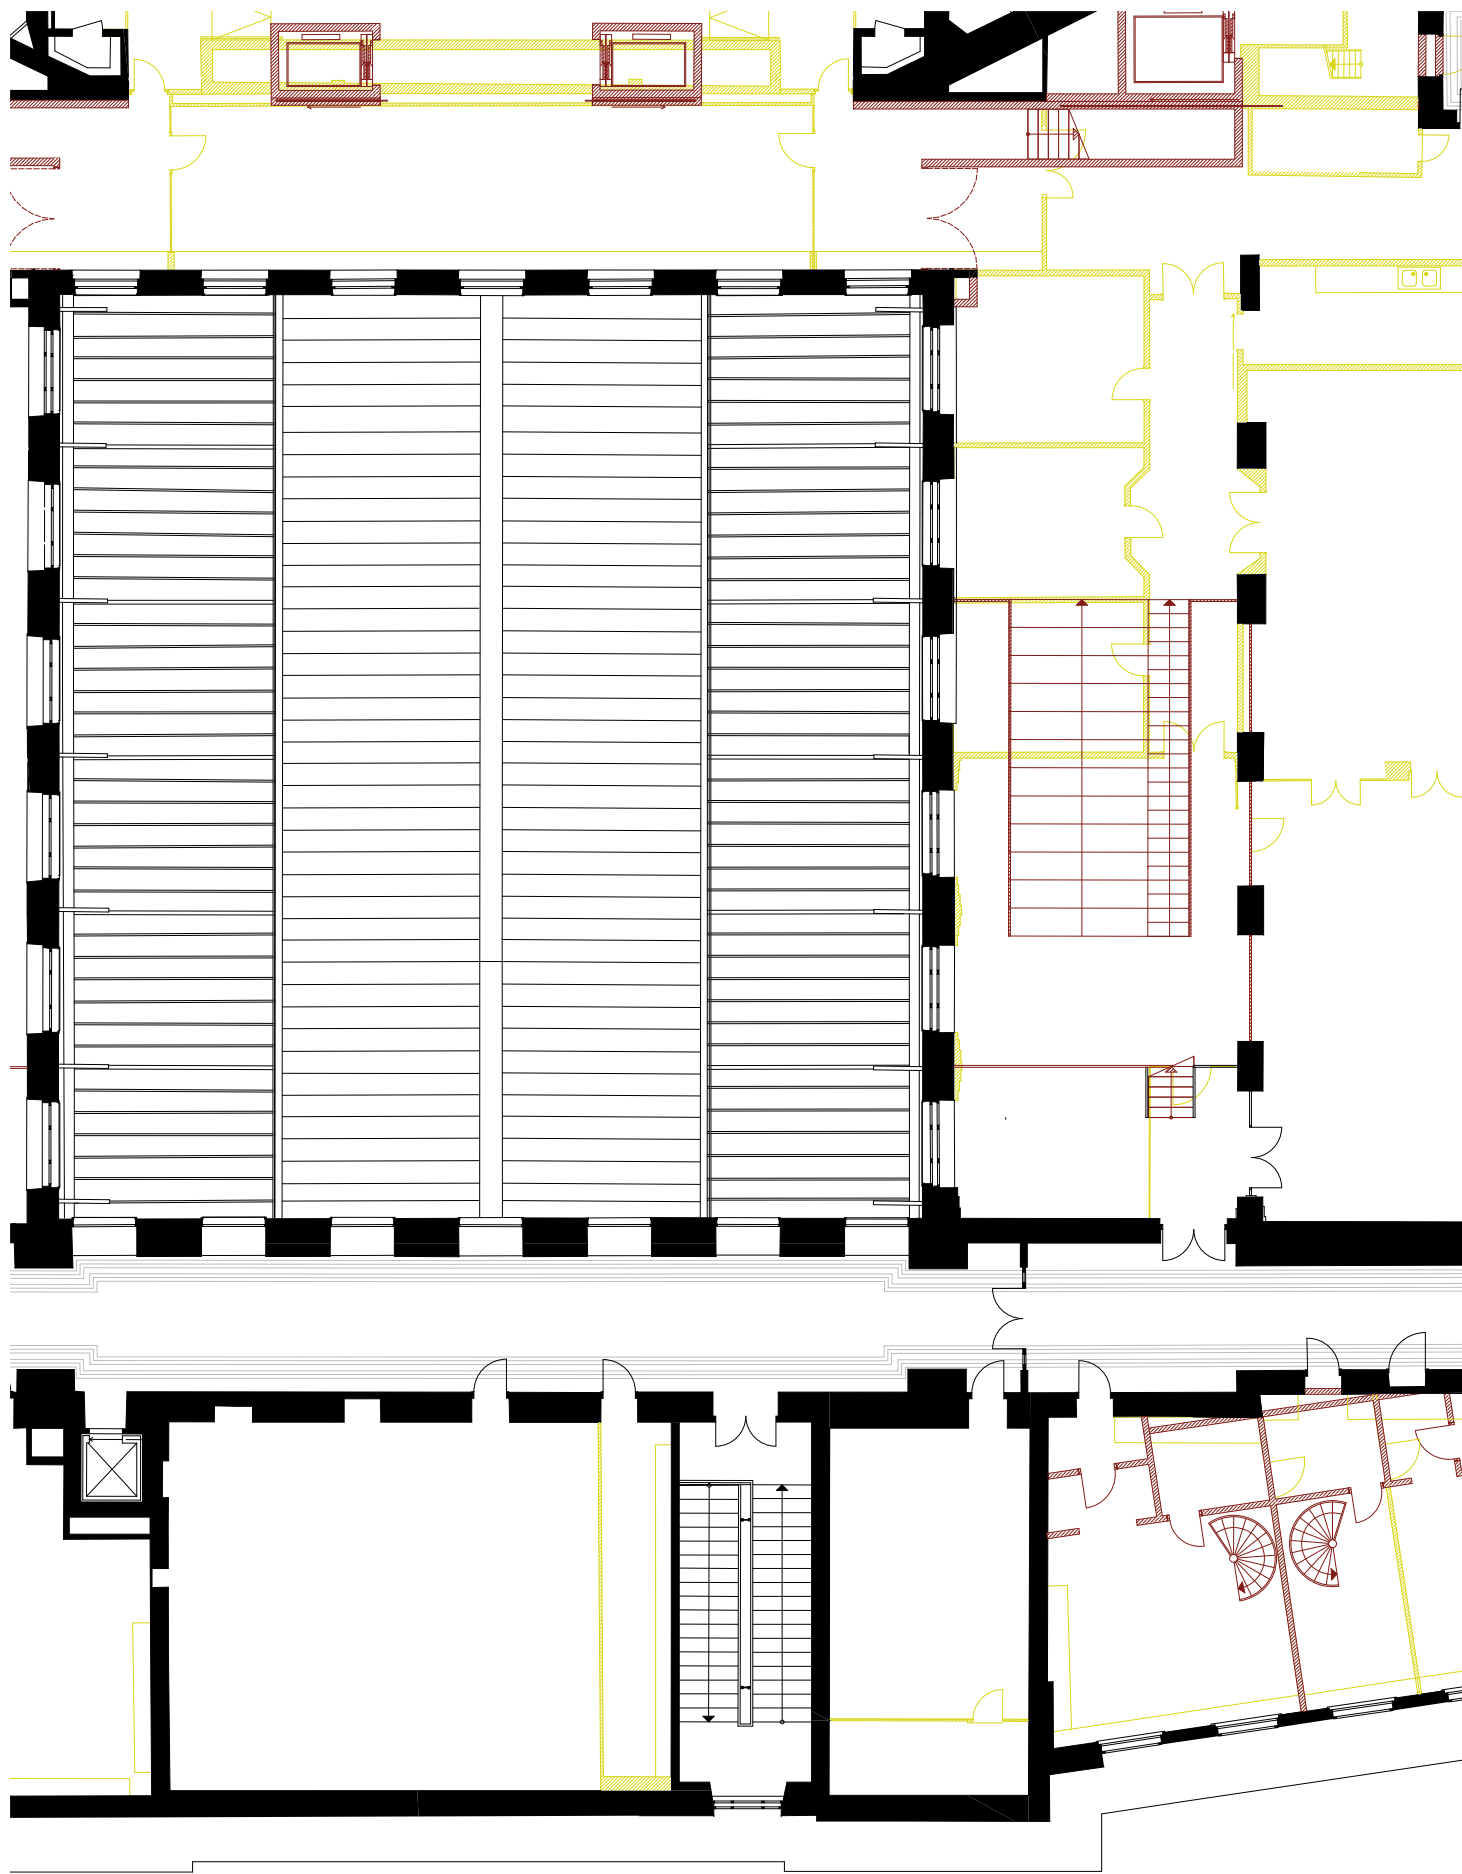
Entwurfsplan Grundriss 5. Obergeschoß
